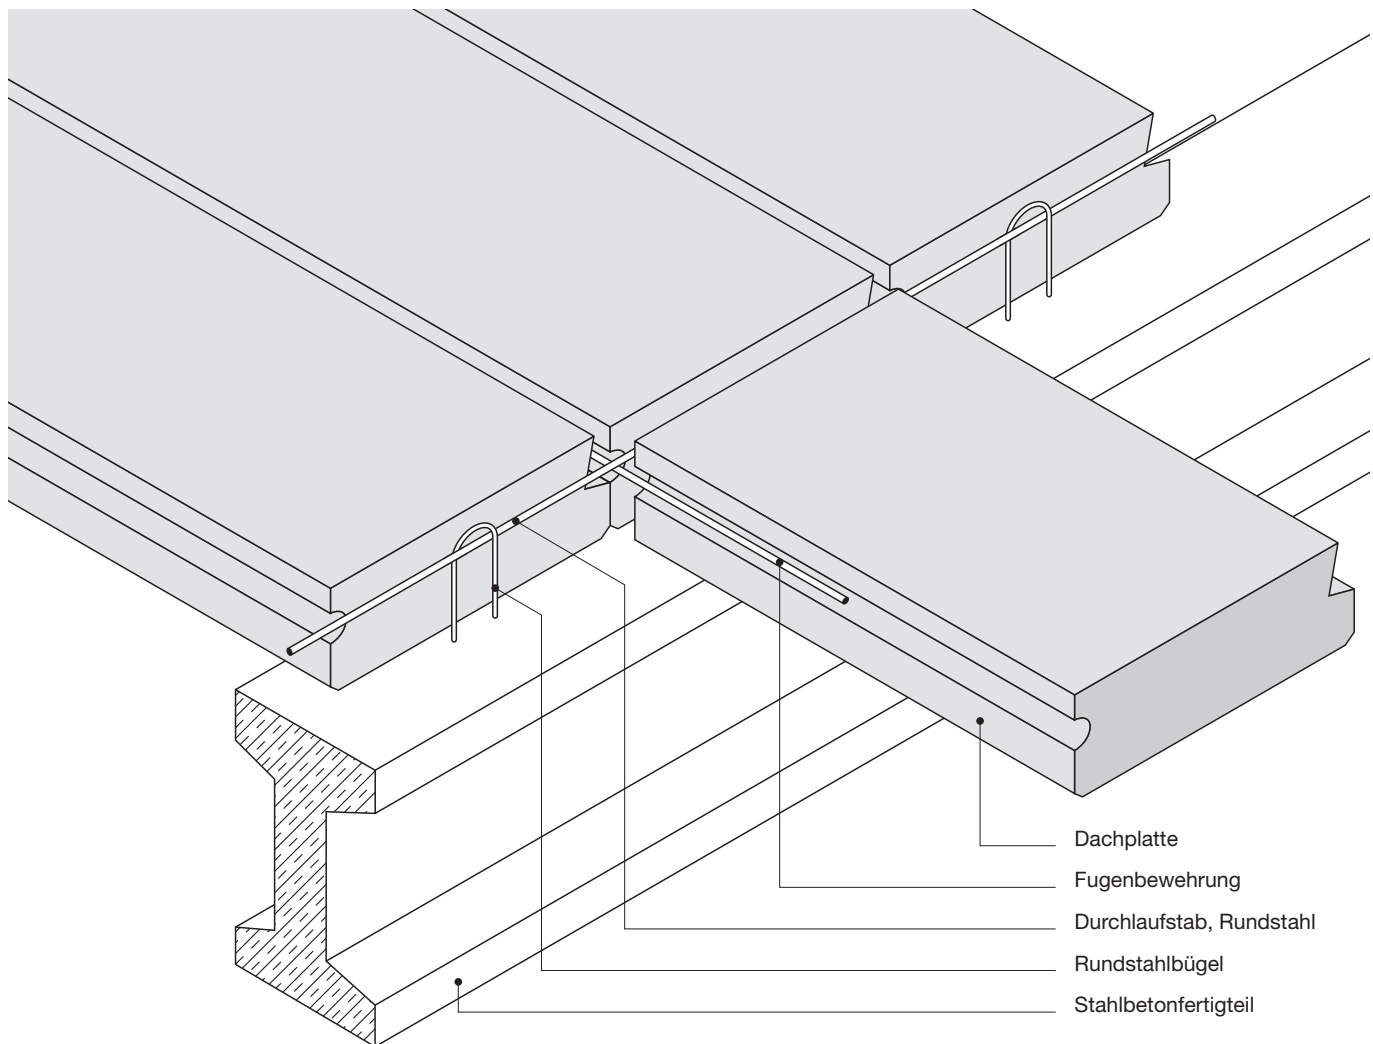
Beispiel für eine Auflagerung von Deckenplatten aus bewehrtem Porenbeton: Verankerung auf einem F 90 bzw. R 90 Stahlbetonträger mit Rundstahlschlaufen
